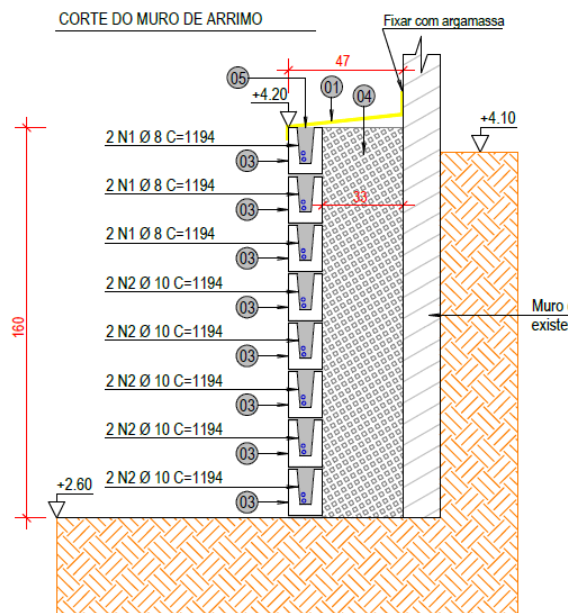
Corte do muro de arrimo localizado aos fundos do Centro de Reservação.
